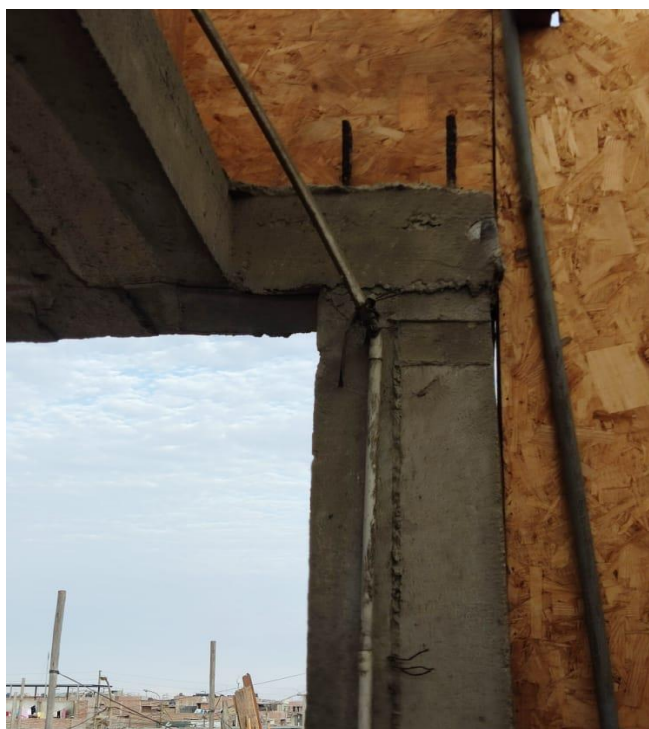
y 28: Tuberías en lugares inadecuados en las viviendas del A.H. Miraflores Bajo.
